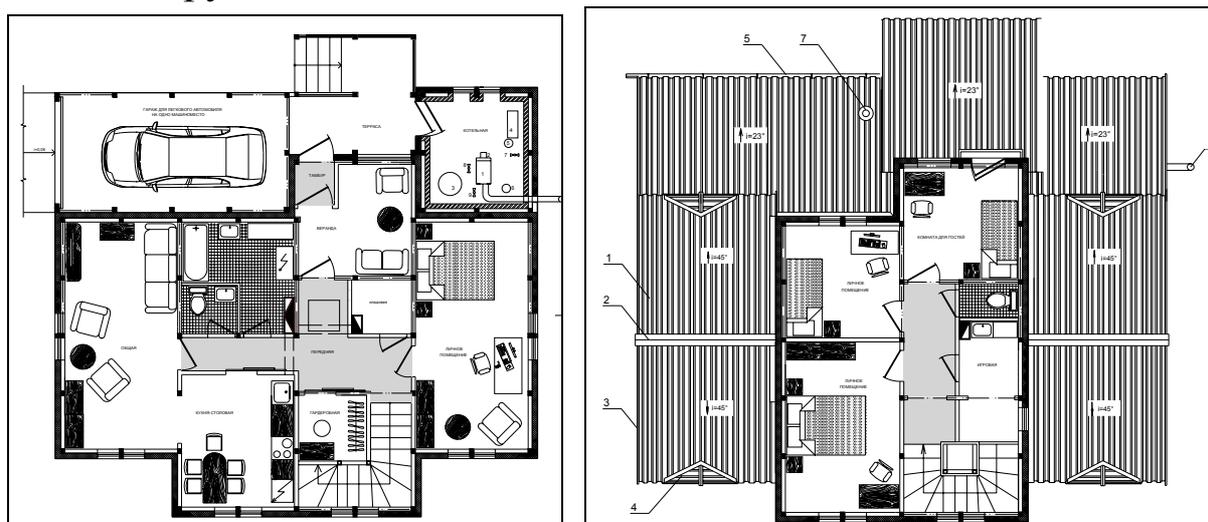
Двухэтажный жилой дом, планы 1 и 2 этажей
